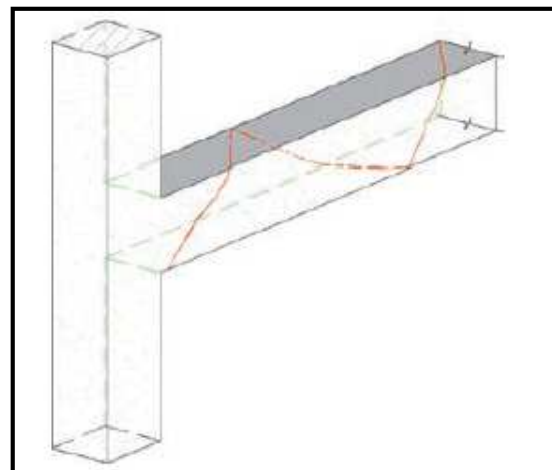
Esquema-Fisuras en viga por Torsión. Imagen en Ref. [5]
